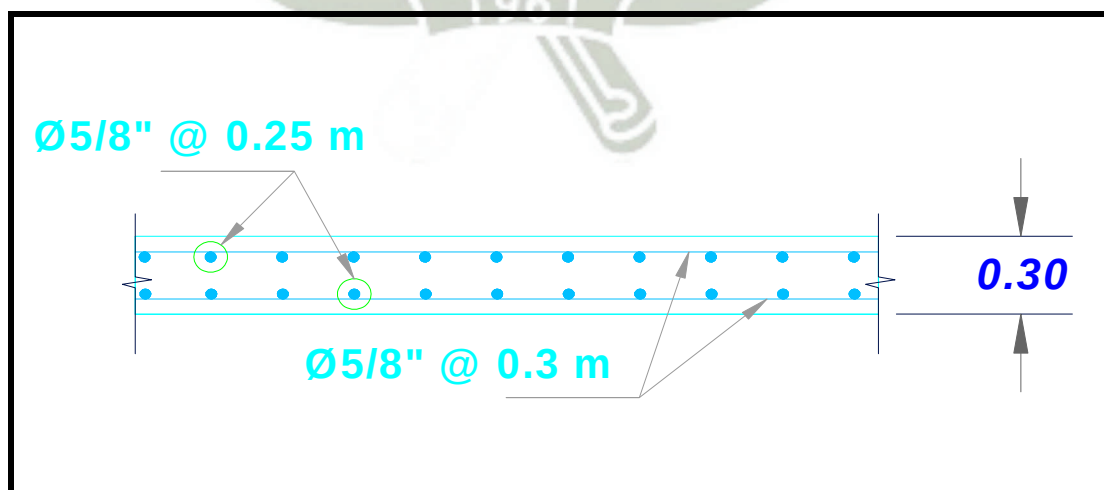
Diseño en Concreto Armado – Losa Inferior del Tablero de Puente
